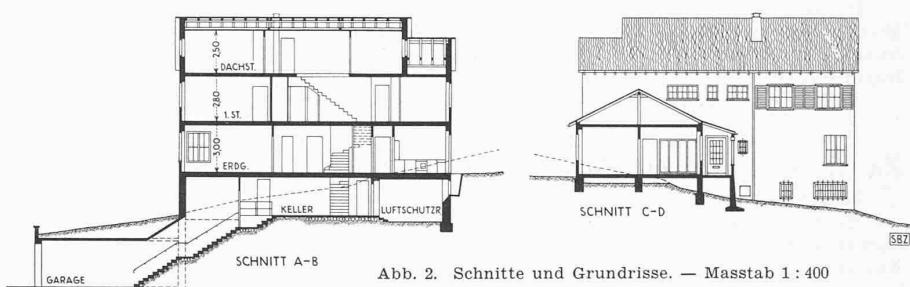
Schnitte und Grundrisse. — Masstab 1:400
